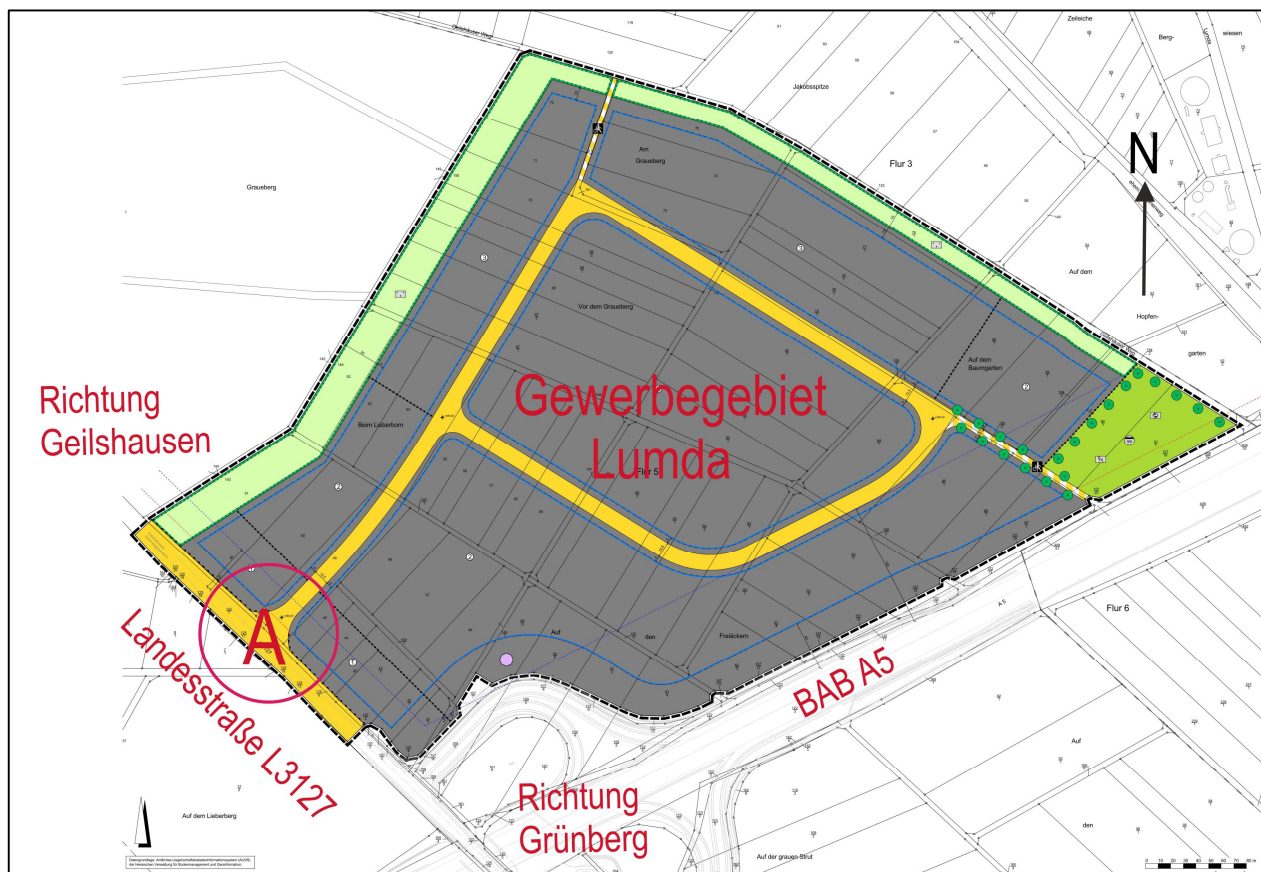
Lage der Entwicklungsflächen „Lumda“ mit dem Anschlussknotenpunkt an die Landesstraße L3127 aus dem Vorentwurf des Bebauungsplans „Gewerbegebiet Lumda“ des Planungsbüros Holger Fischer, 35440 Linden, vom 12.09.2019, rote Beschriftung ergänzt
